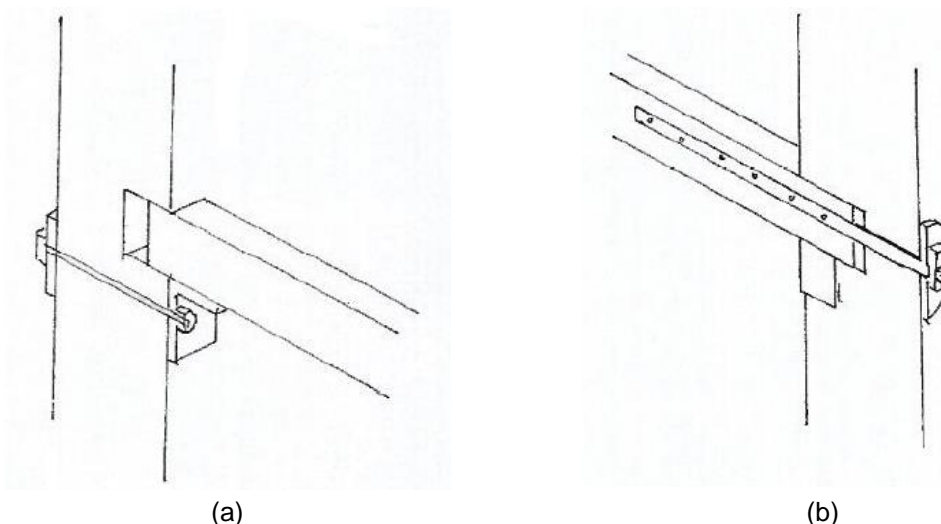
Pormenor da ligação dos pavimentos às paredes resistentes: (a) utilização de chapas quinas na base das vigas de madeira; (b) utilização de chapas metálicas aplicadas no centro das vigas de madeira [21]
